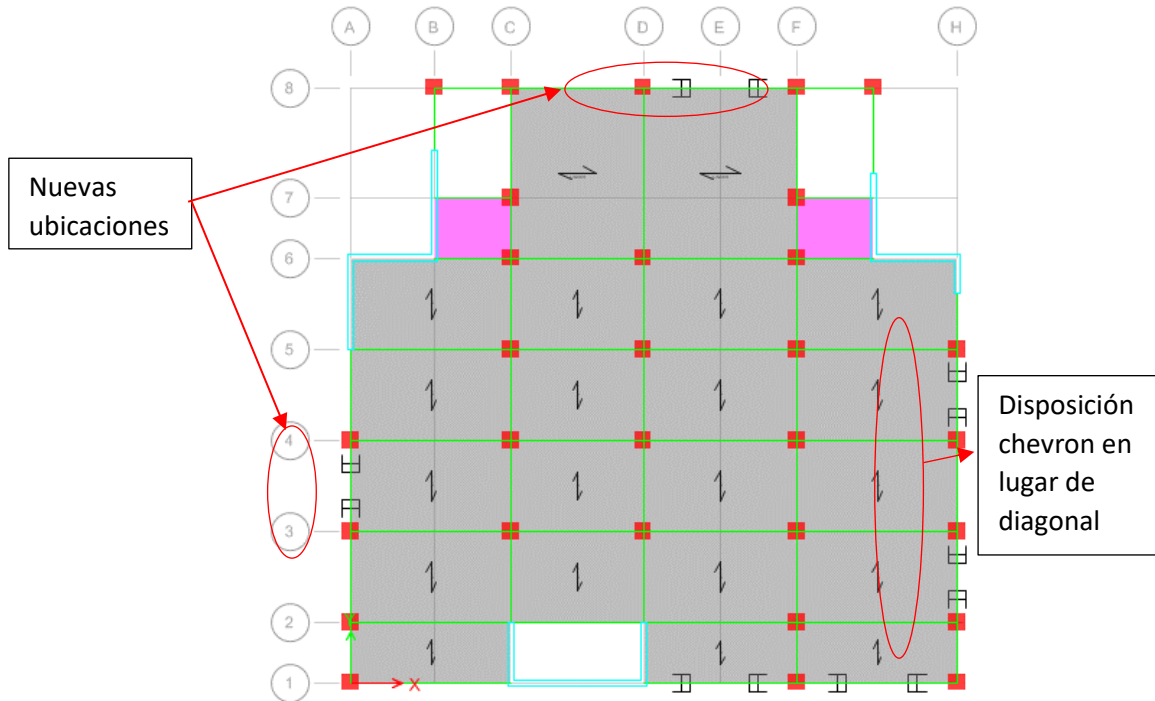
Vista en planta, segundo caso de ubicación de dispositivos
